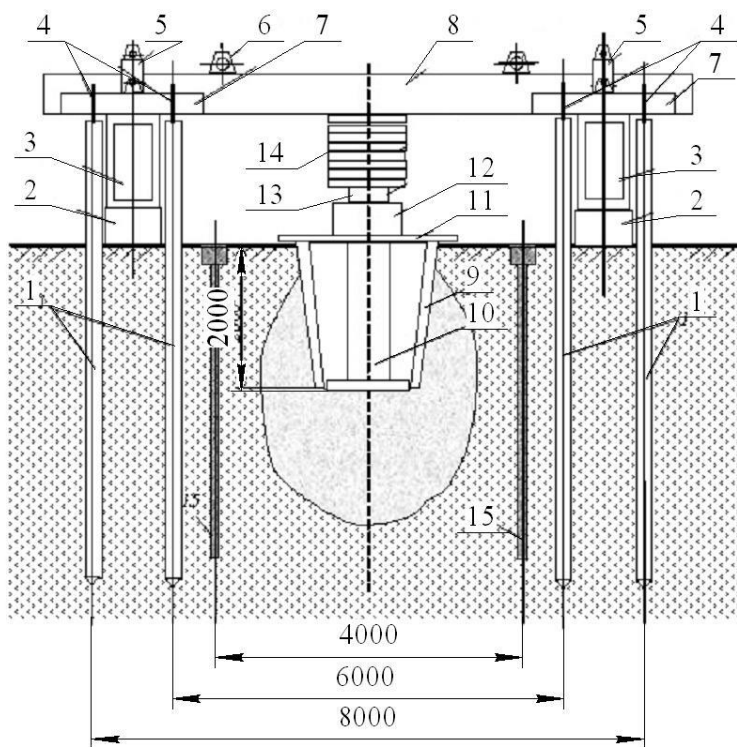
Стенд для исследования формирования уплотненной зоны при погружении фундаментов-оболочек в грунт в условиях строительной площадки.
